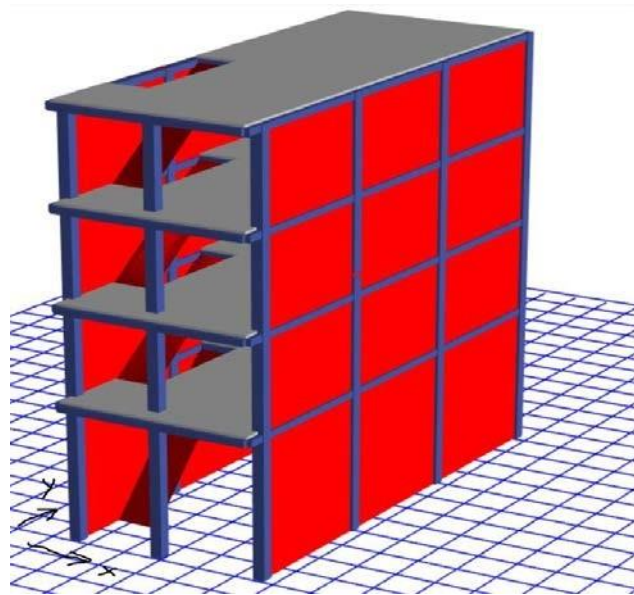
Modelamiento en Etabs vivienda autoconstruida 2
